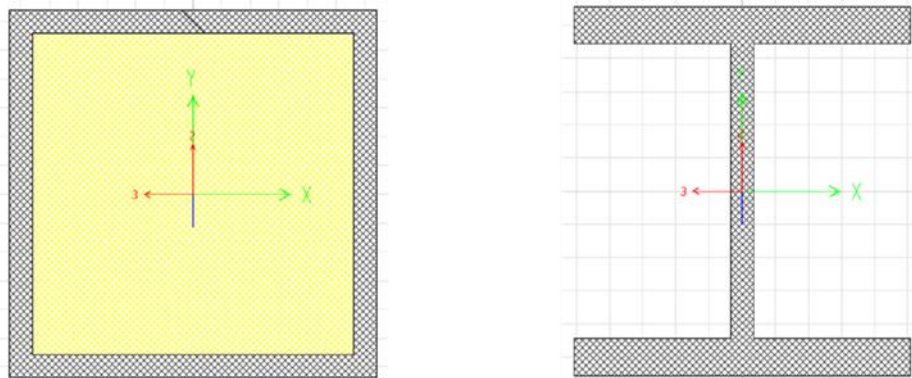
Columna Compuesta CFT y Viga de Perfil W
